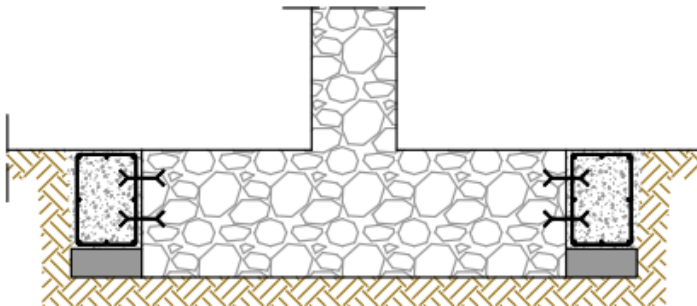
Sección zapata aislada. Refuerzo 1. Fuente propia.
